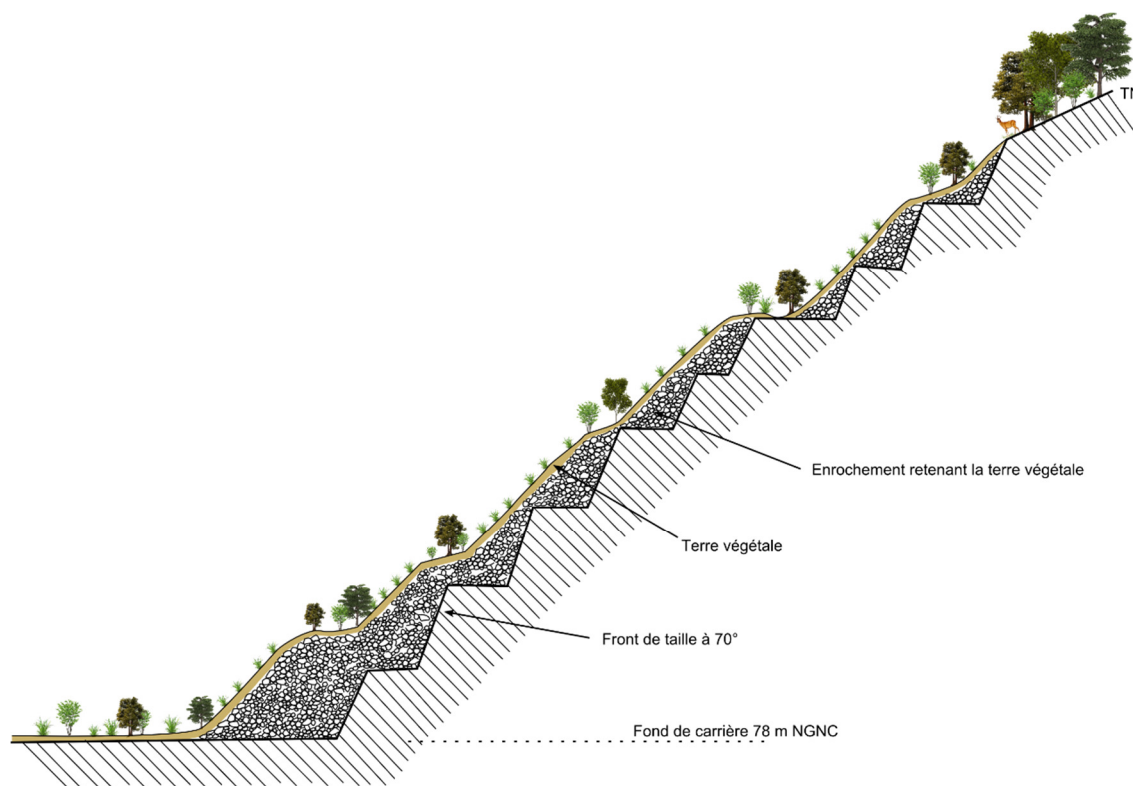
Coupe du front de taille après des travaux ramenant la pente générale à 45°
